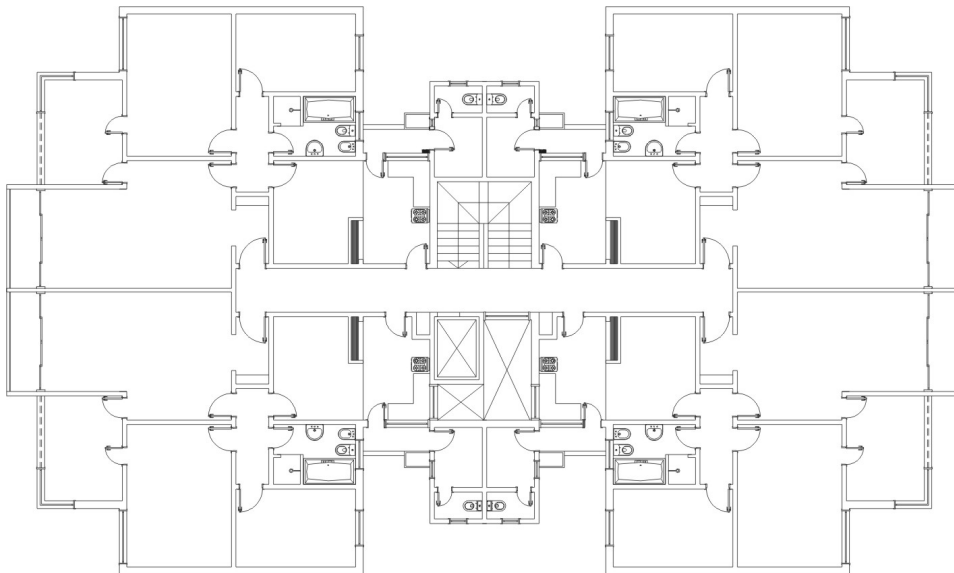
Edifício Mussi: planta baixa do pavimento tipo. Fonte: 11ºSR IPHAN.
